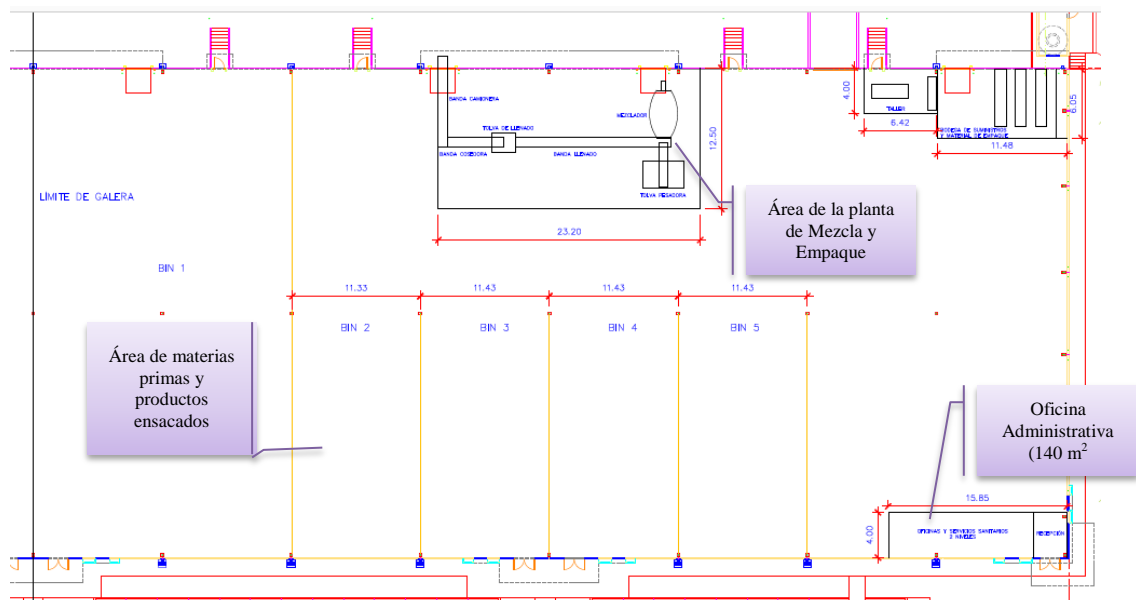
Distribución (planta arquitectónica) del área de la planta mezcladora
